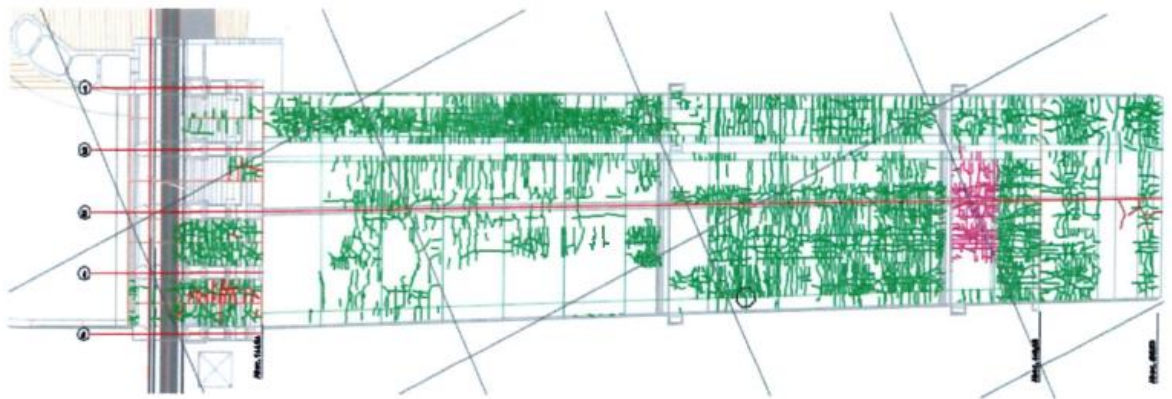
Vista en planta del vertedero con patrón de fisuración (plano ACAD-PHI-ESQ-042-0190-R15-Model)
